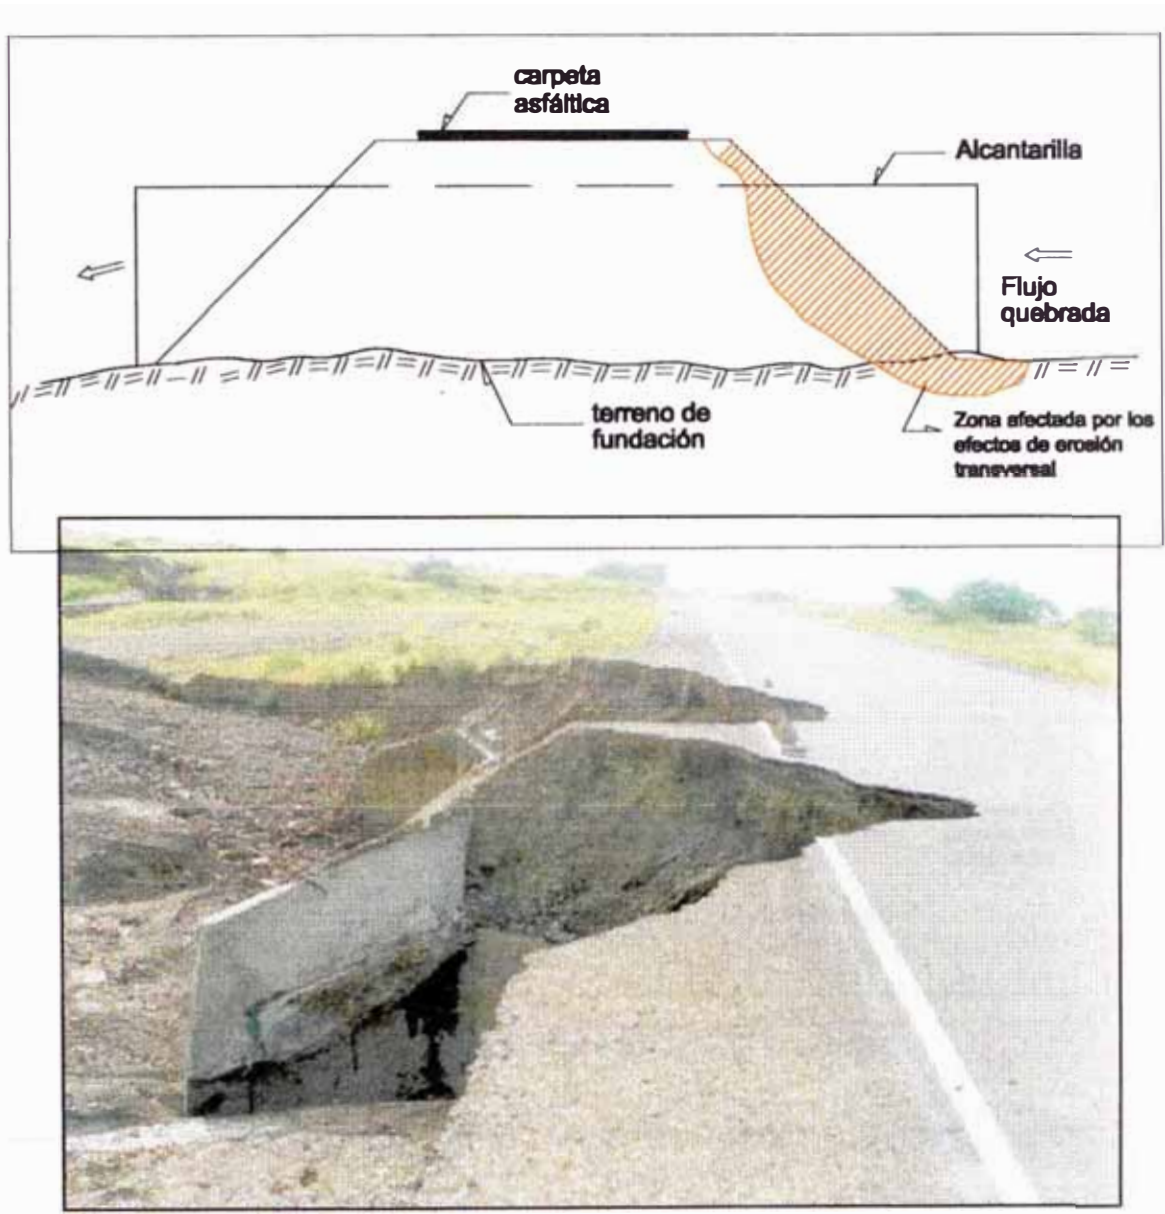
Efecto de socavación transversal que afectó al terraplén adyacente a la obra de cruce.
